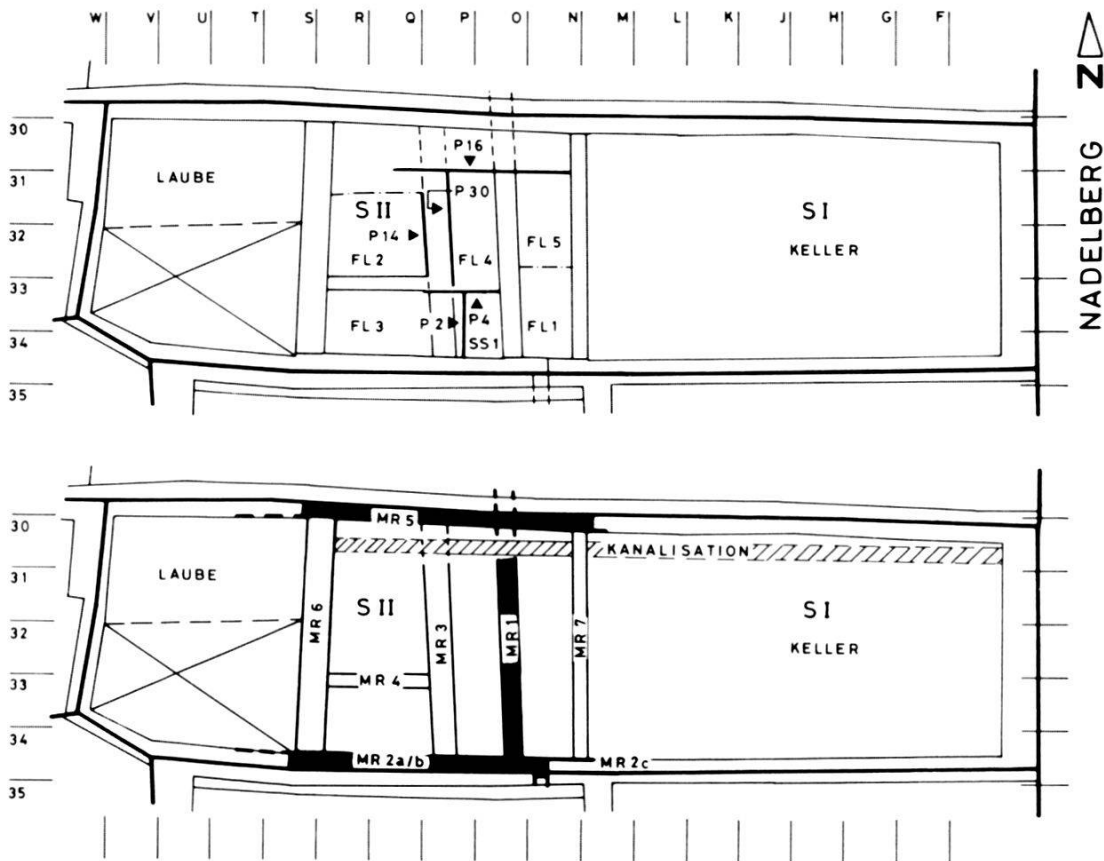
Nadelberg 32, 1987/16. Mauer- und Flächenplan: die Lage der in Abb. 42 dargestellten Profile ist eingetragen. – Zeichnung: U. Schön. – Massstab 1:200.
